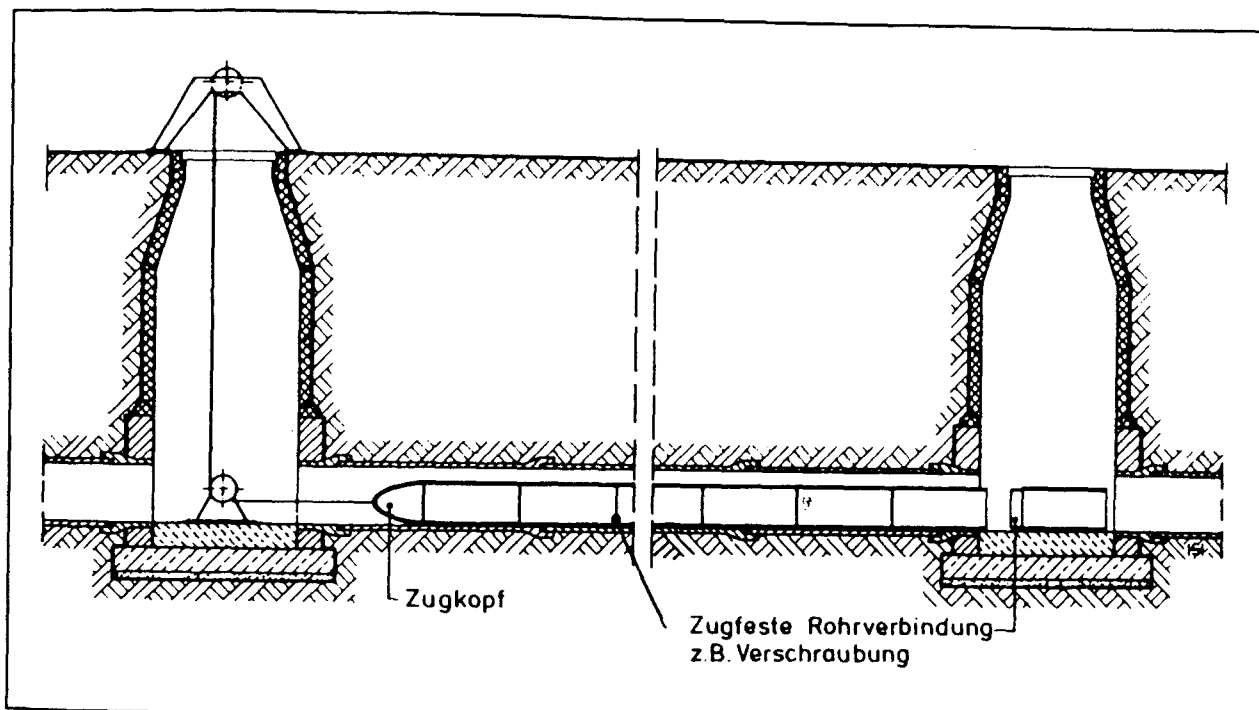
Einziehen eines Rohrstranges aus Kurzrohren mit zugkraftschlüssiger Verbindung
